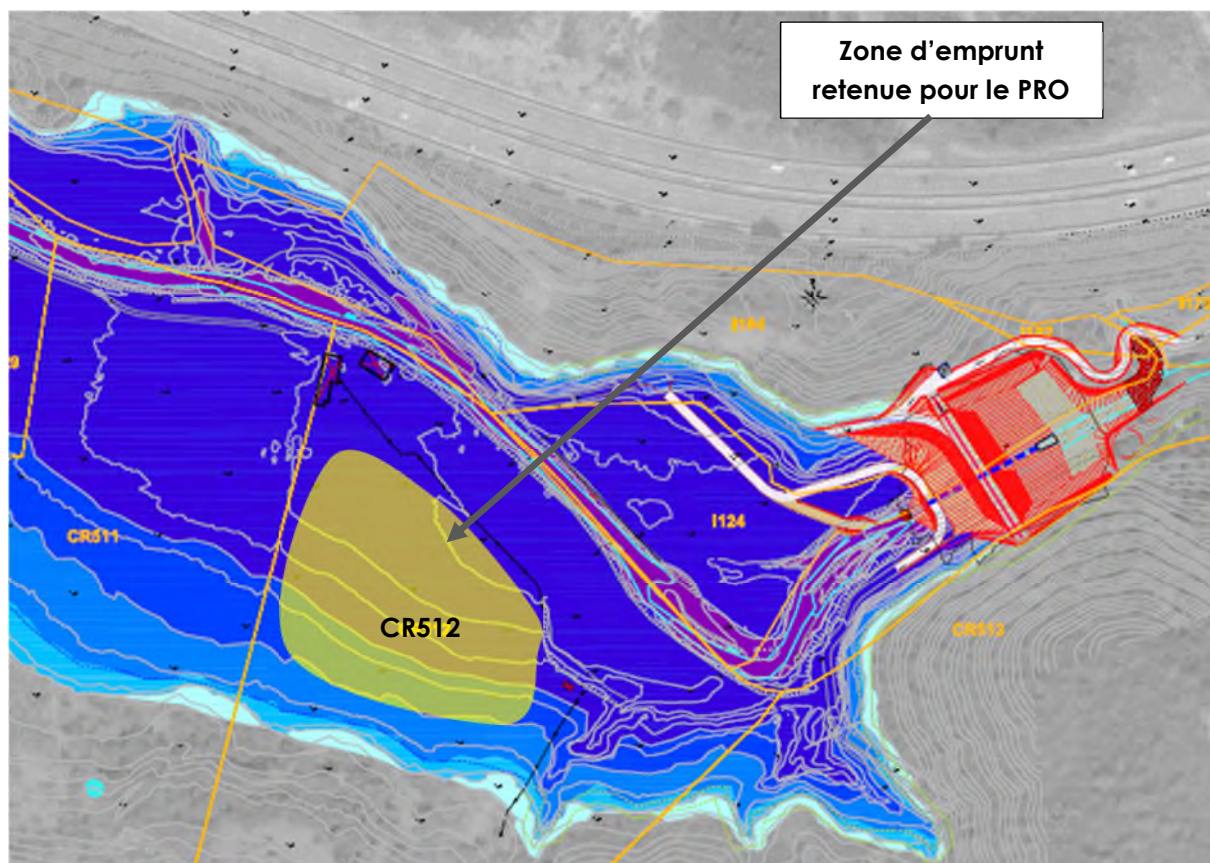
Plan de principe de la zone d'emprunt retenue pour le PRO sur fond de plan n°2 de l'AVP
